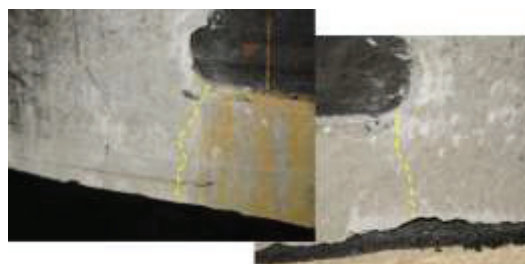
Rissbildung ausgehend von den unteren Eckpunkten der Schieneneinlagerung zum Boden der Betonplatten (Risse zur Verdeutlichung in gelb nachgezeichnet)
